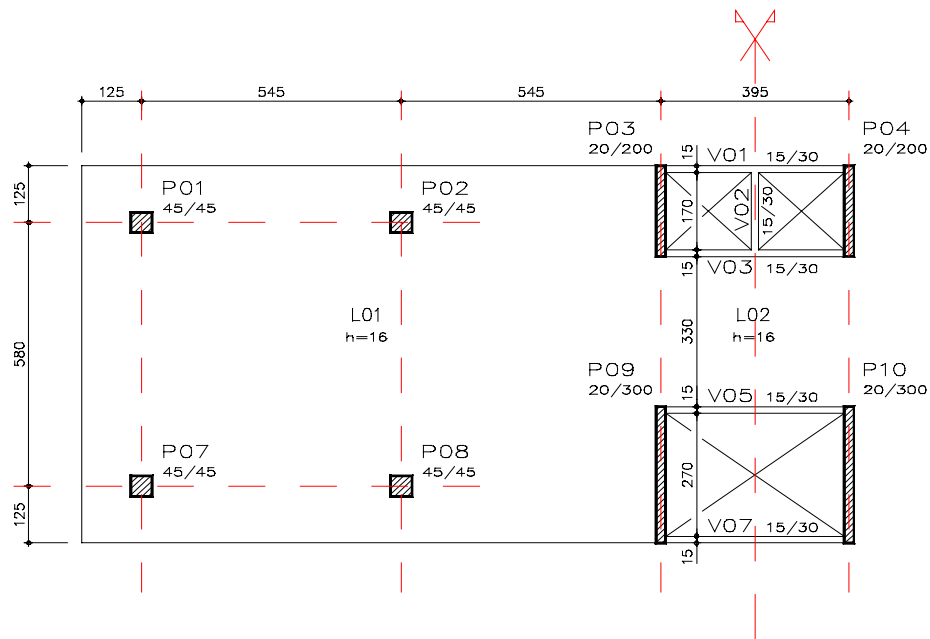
Pavimento tipo - laje plana (medidas em 'cm')
